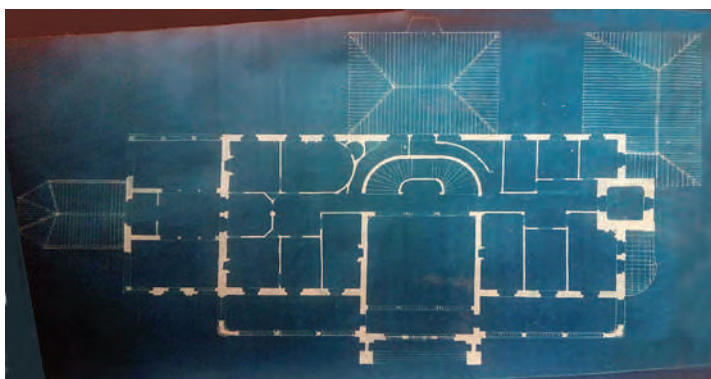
Plano de la planta alta del proyecto "neomudéjar", sin fecha ni firma (Archivo Fundación González Byass Jerez).
